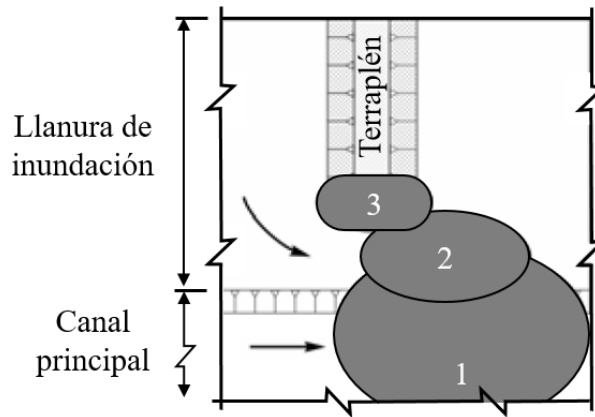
Tres zonas comunes de socavación en estribos o terraplenes de acceso debido al estrechamiento (IHRB, 2006).
